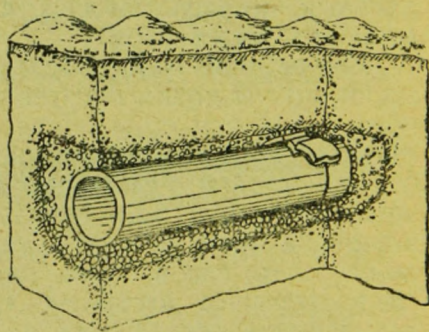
Защита соединений труб, уложенных краями друг к другу. Несколько обломков черепицы или труб уложены на соединениях во избежание попадания земли внутрь трубы.
